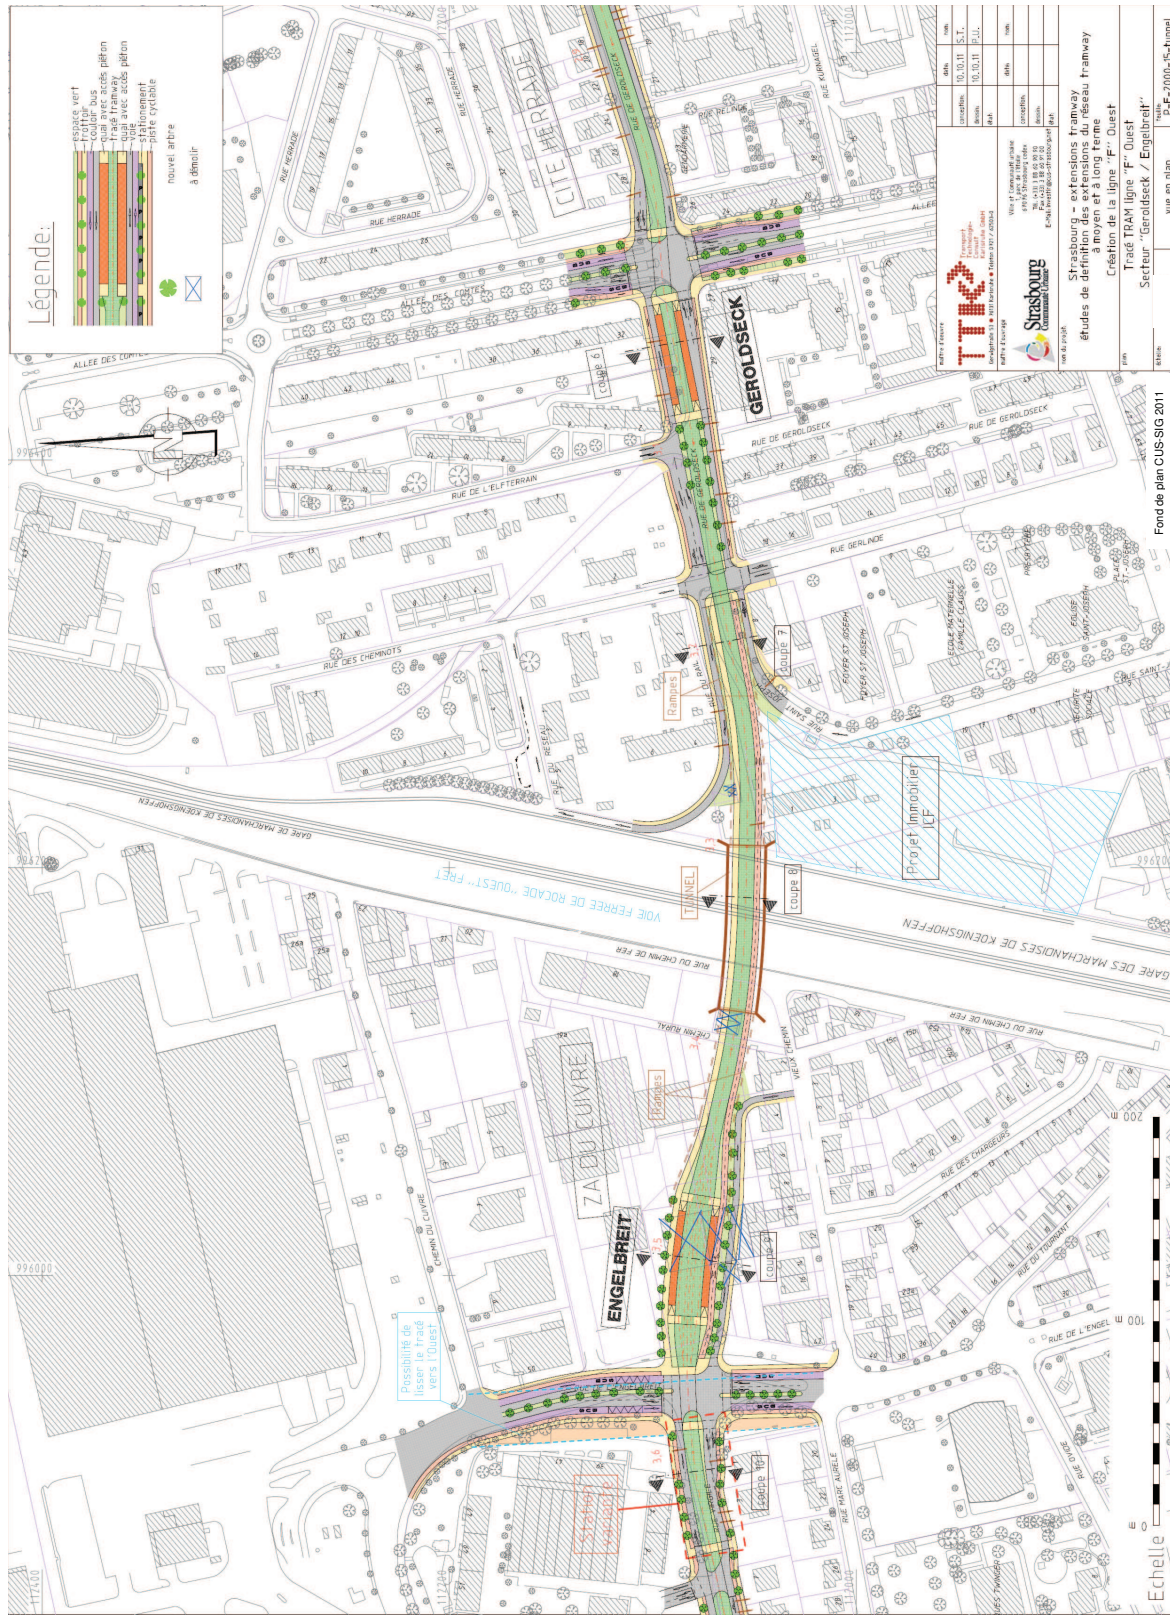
Plan d'insertion du tramway pour le franchissement des voies ferrées de rocade fret Ouest, variante "Tunnel" (échelle 1/2500 ème).
